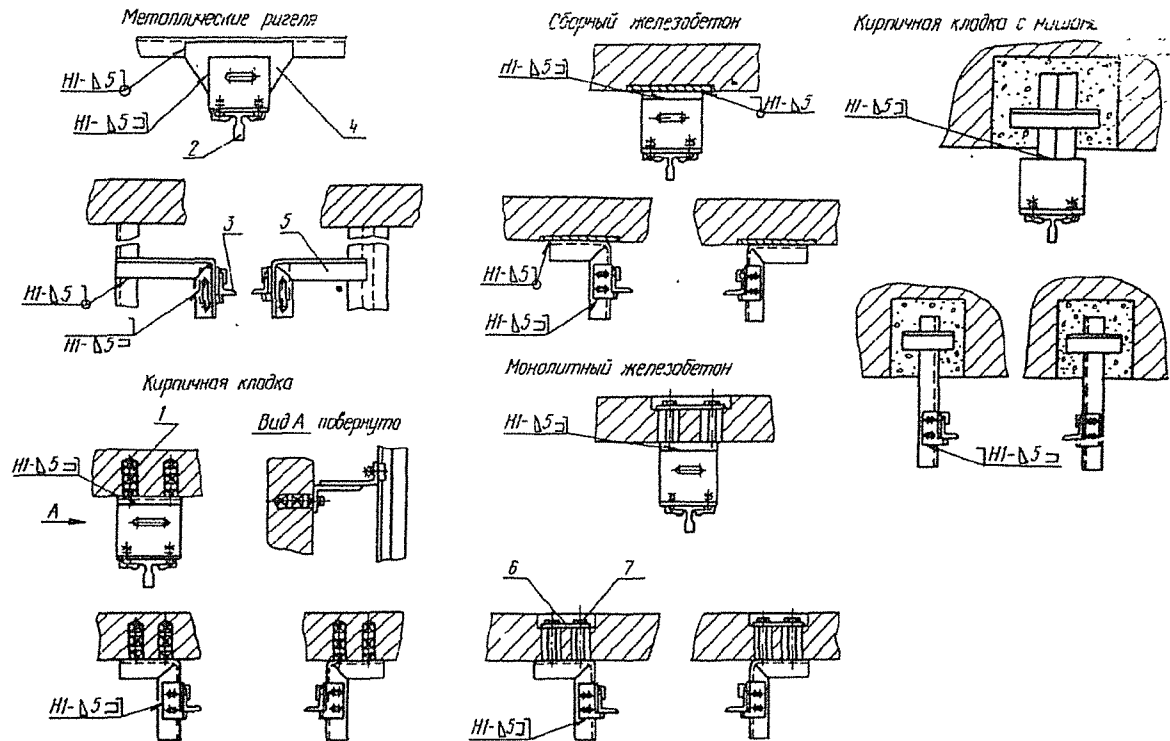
Крепление направляющих кабины и противовеса при заднем его расположении:
